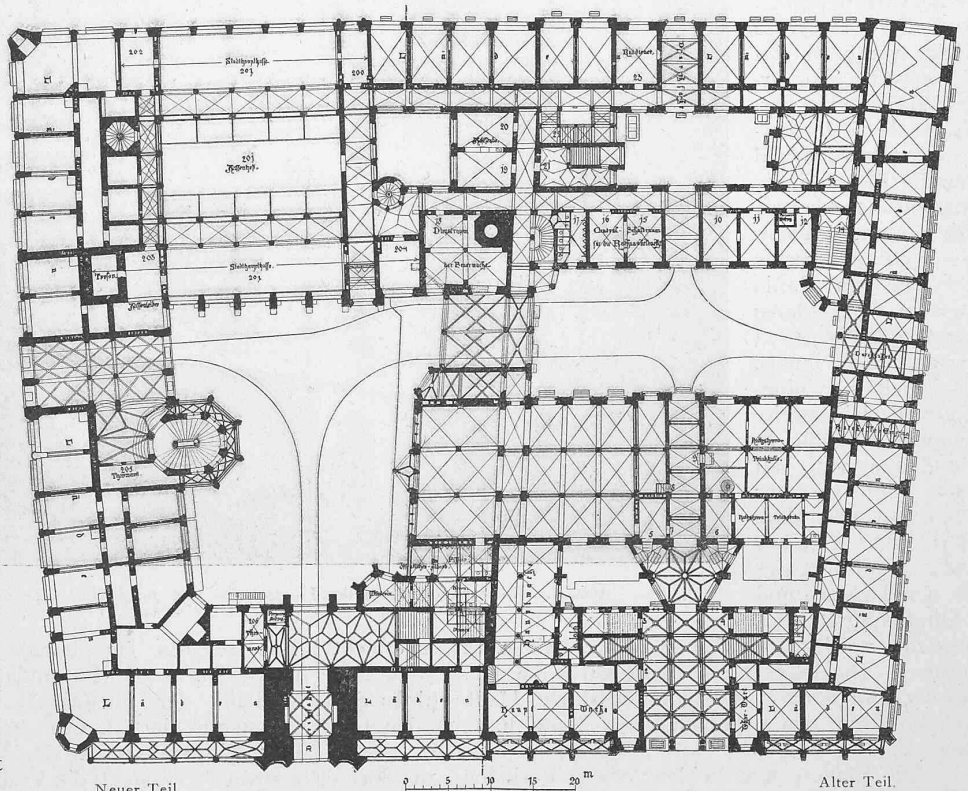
Grundriss vom Erdgeschoss. — Masstab 1 : 800.
